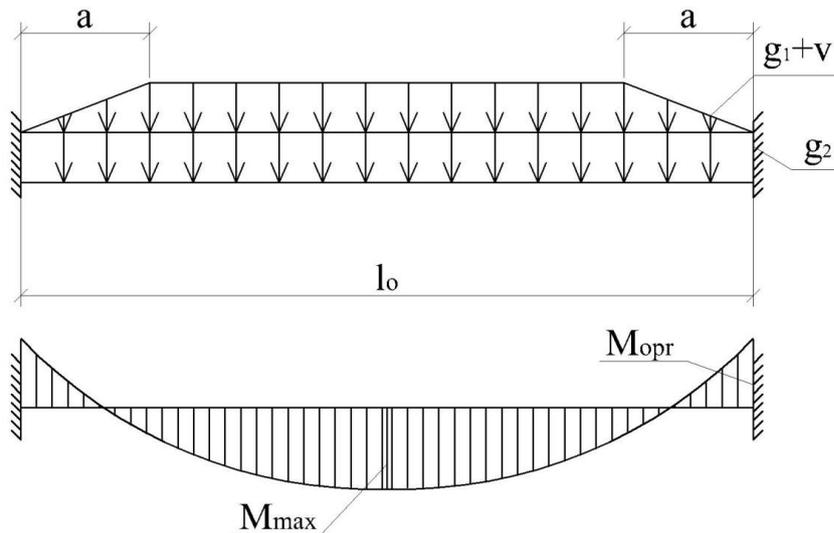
Расчетная схема и эпюра изгибающих моментов поперечного ребра a – участок снижения нагрузки, равный $a=0.5d$, где d – шаг поперечных ребер
